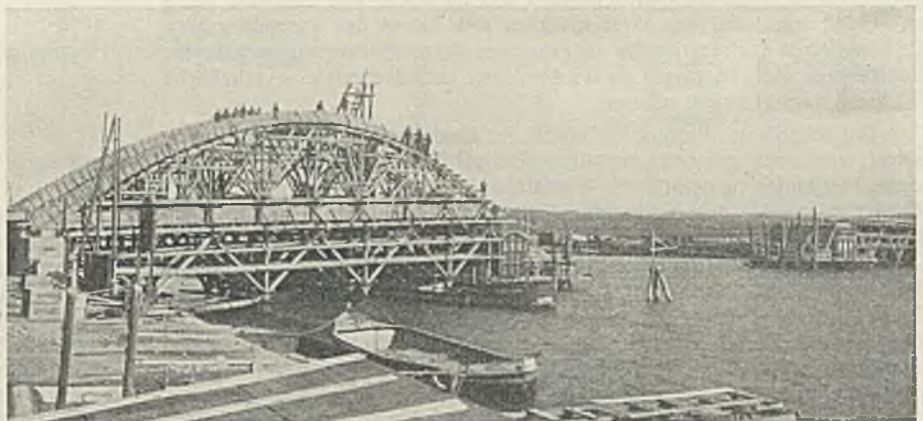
Lehrgerüst für den stadtseitigen Brückenbogen.
